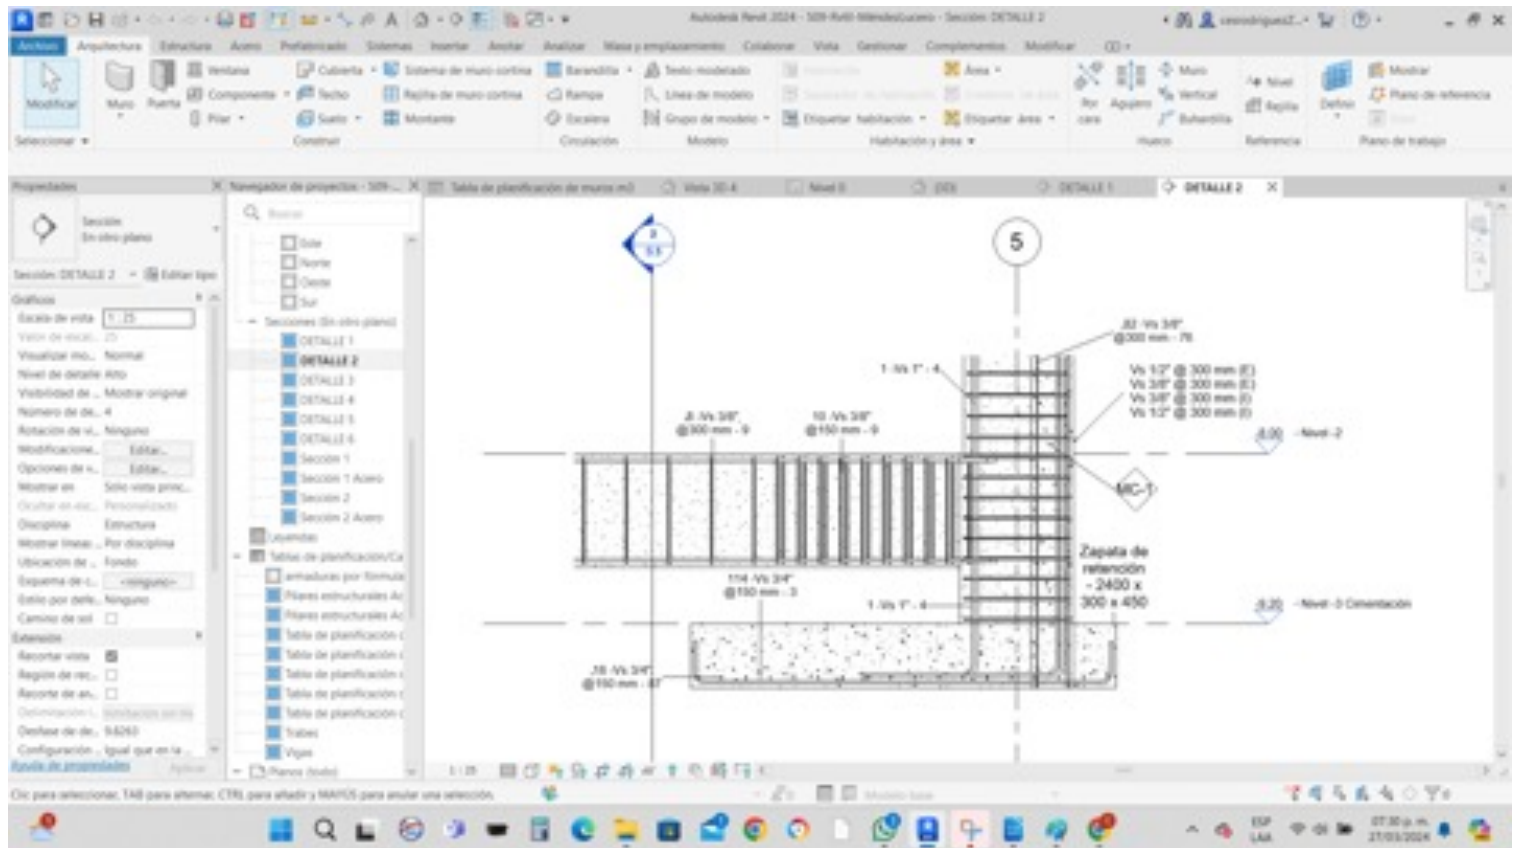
Detalle elementos de concreto: unión Zapata – Columna - Contra trabe Lucero Elizabeth Mendez Licona
